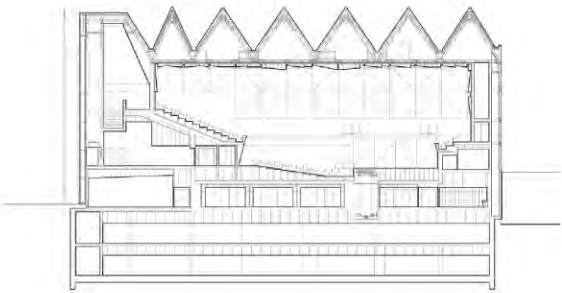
Sección Longitudinal - Salas de Conciertos.
